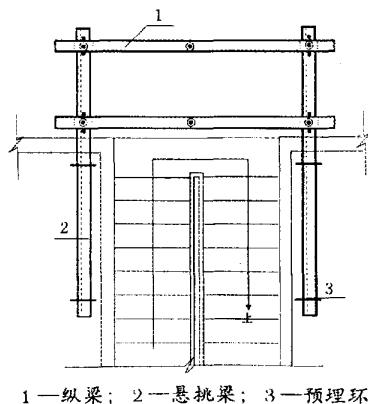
靠外墙楼梯部位纵梁布置平面图
